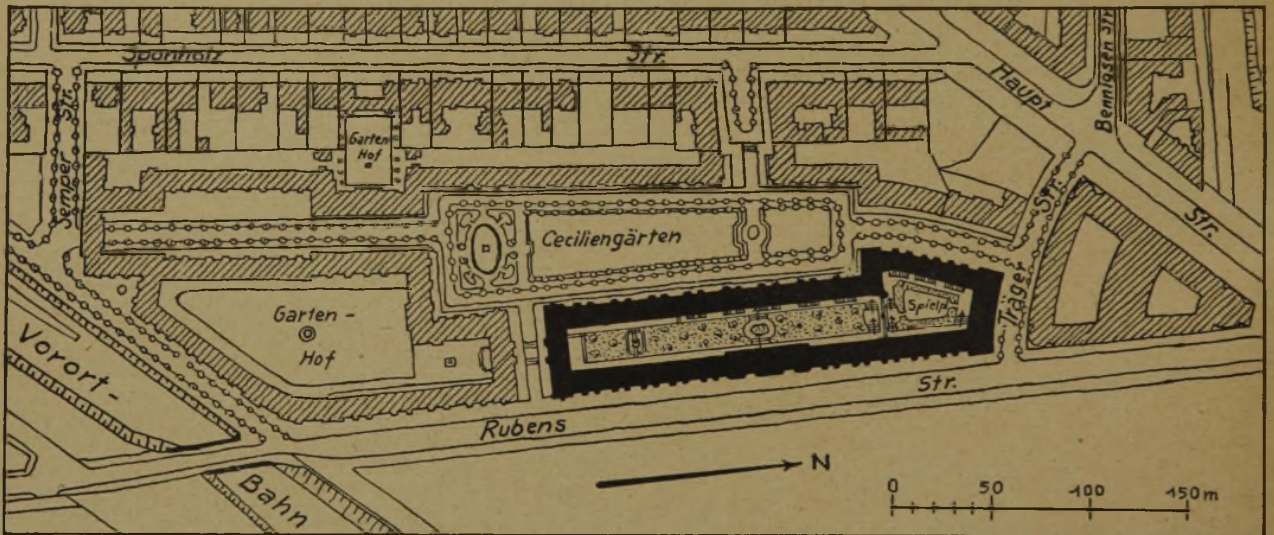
Wohnhausgruppe Schöneberg, Ceciliengärten. Lageplan. (1 : 3750.)
